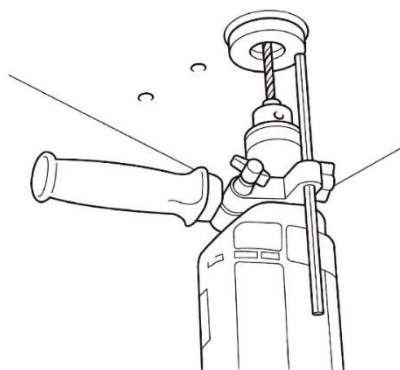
Сверление с контейнером для сбора пыли
